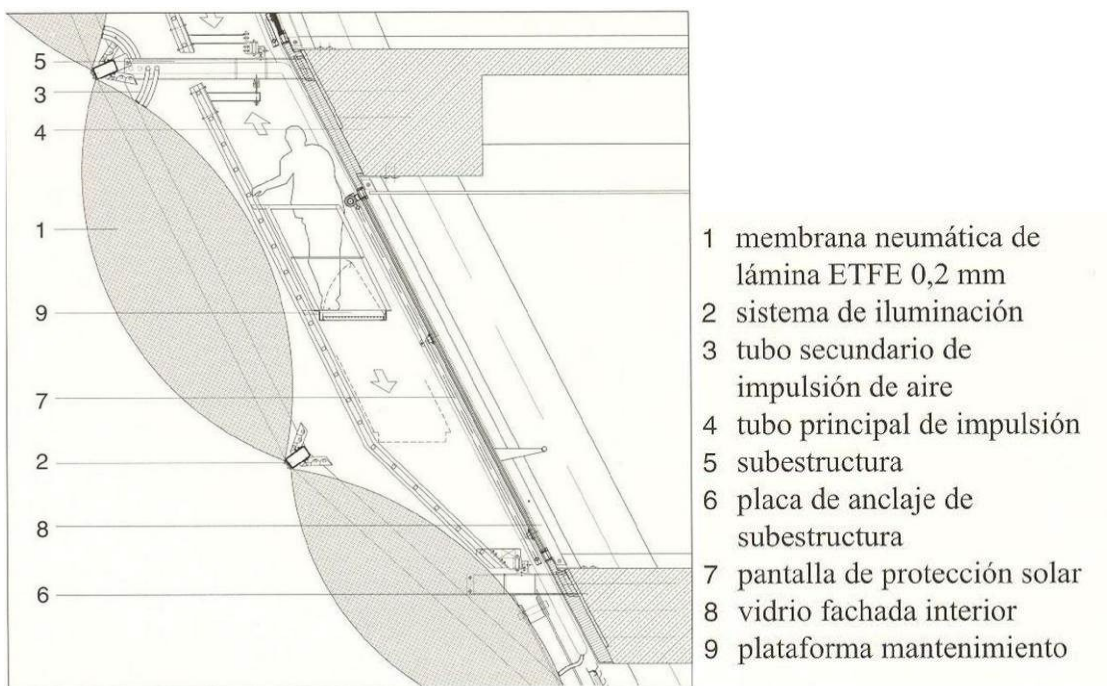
Detalle Fachada Allianz Arena / *fuelle:* Archidaly
